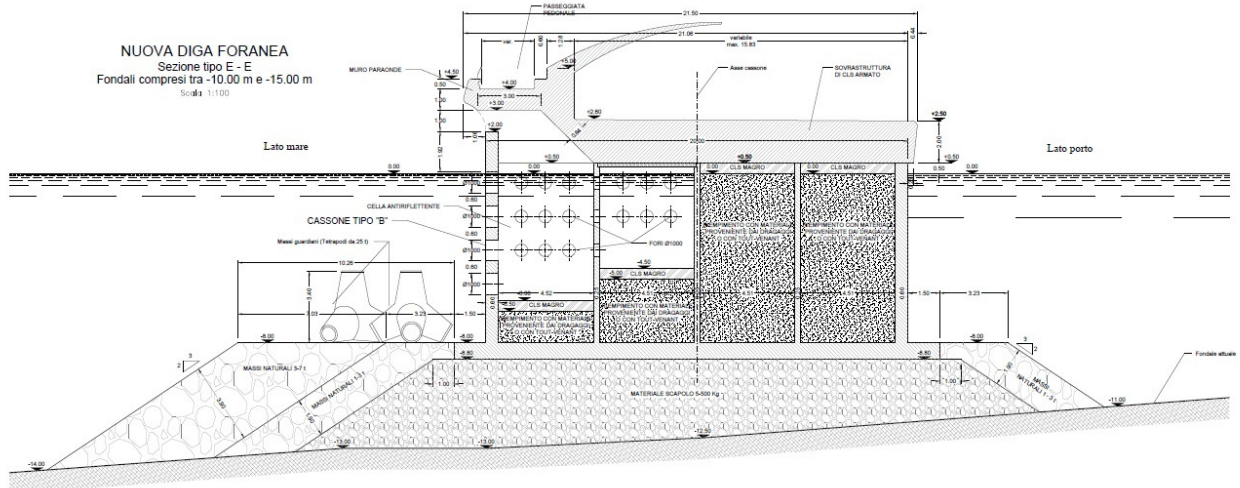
Sezione tipo della diga foranea per fondali compresi tra 10,00 m e -15,00 m
